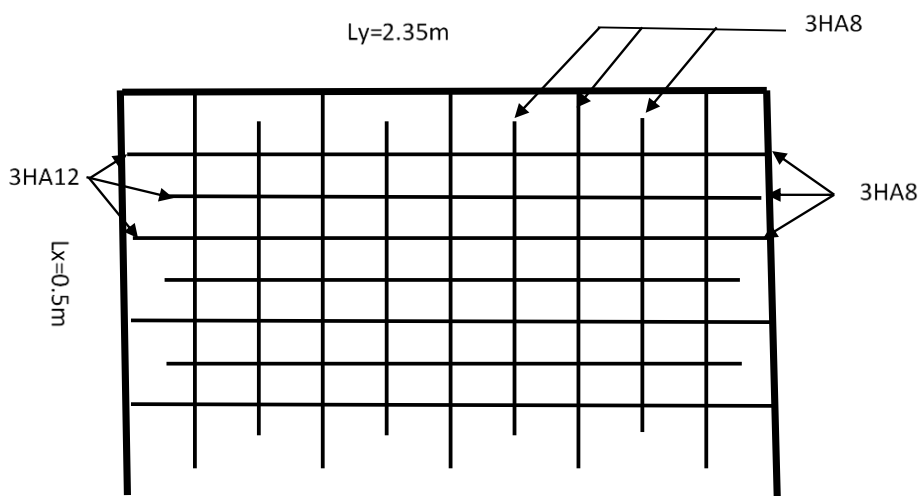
Schéma de ferrailage de la dalle pleine sur 3 appuis
